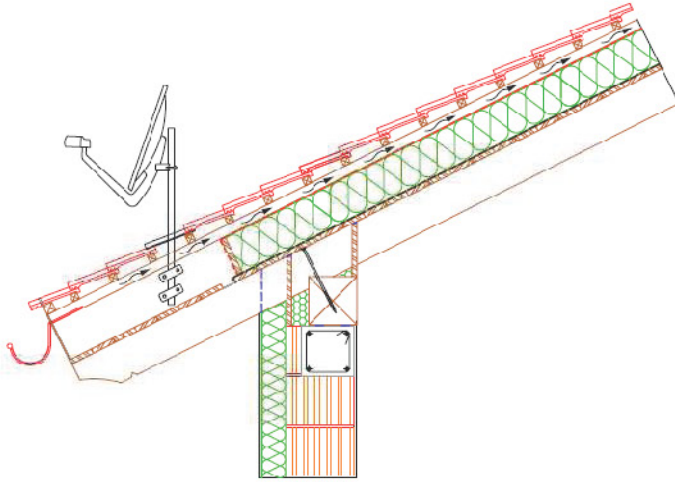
particolare costruttivo nella zona di intersezione con il setto verticale
